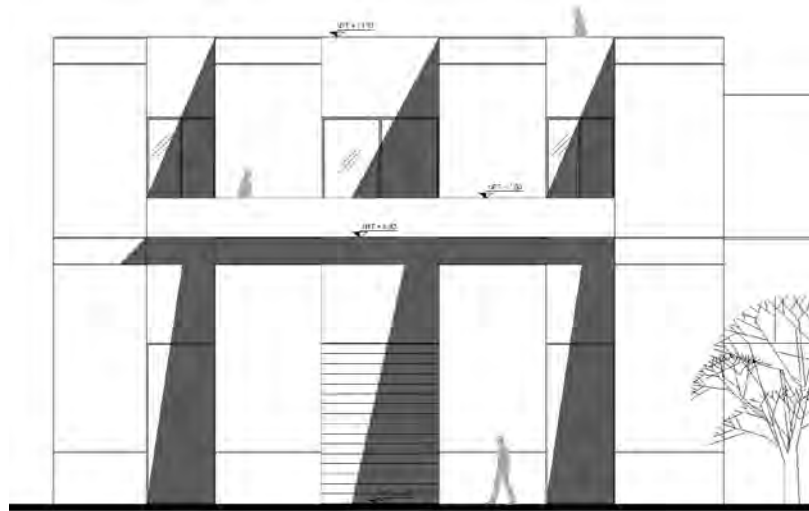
Fachada Lerdo del nuevo edificio en concreto blanco aparente y balcón de cristal.
